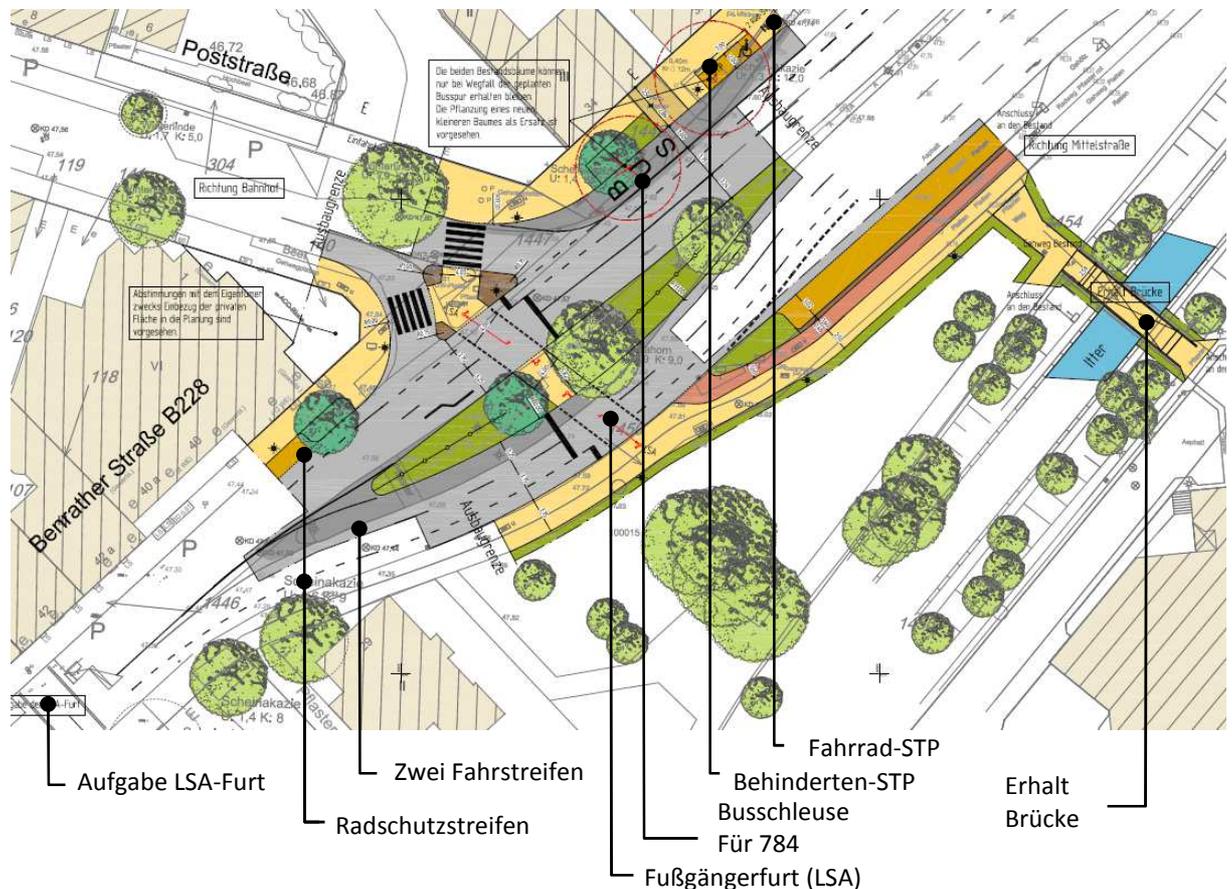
Ausschnitt aus der Planung Variante „Erhalt Brücke“
